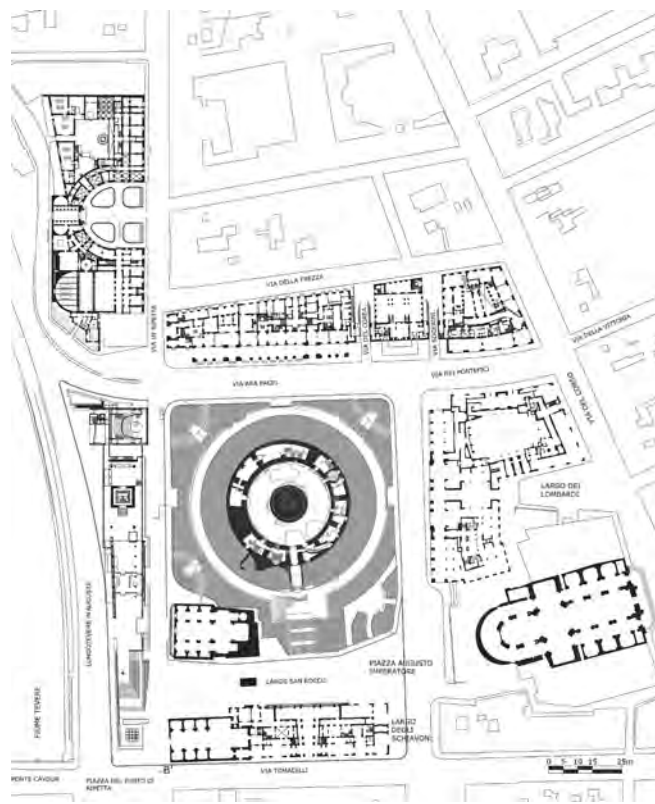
Planimetria con piante dei piani terra degli edifici che si affacciano su Piazza Augusto Imperatore.
